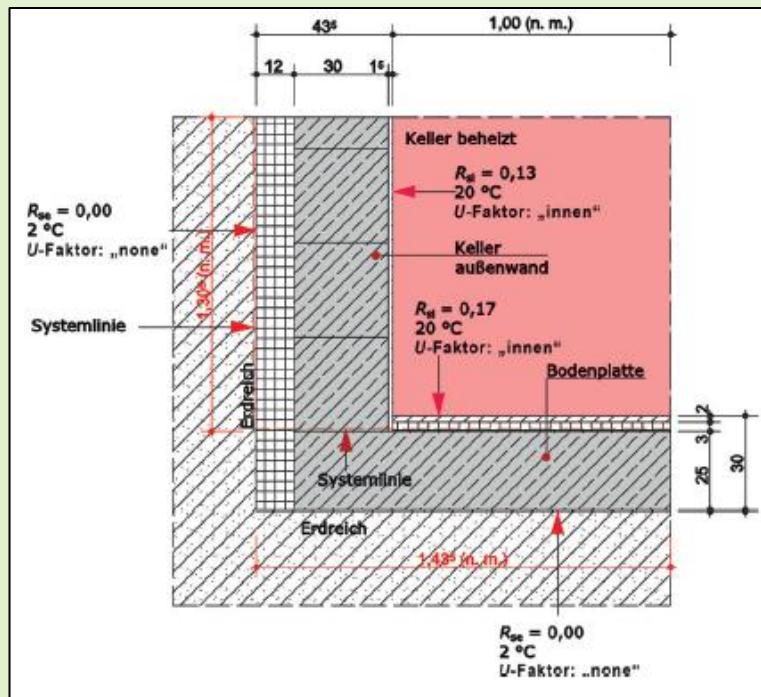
Anschluss Kelleraußenwand auf Bodenplatte
